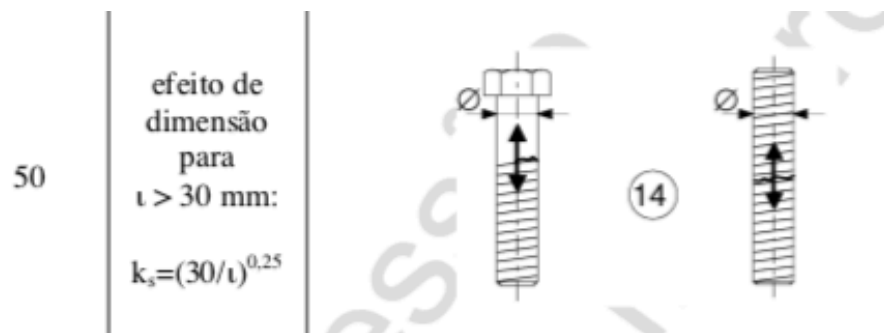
Pormenor DC 50 utilizado nas ligações aparafusadas (Eurocódigo 3 2010).
